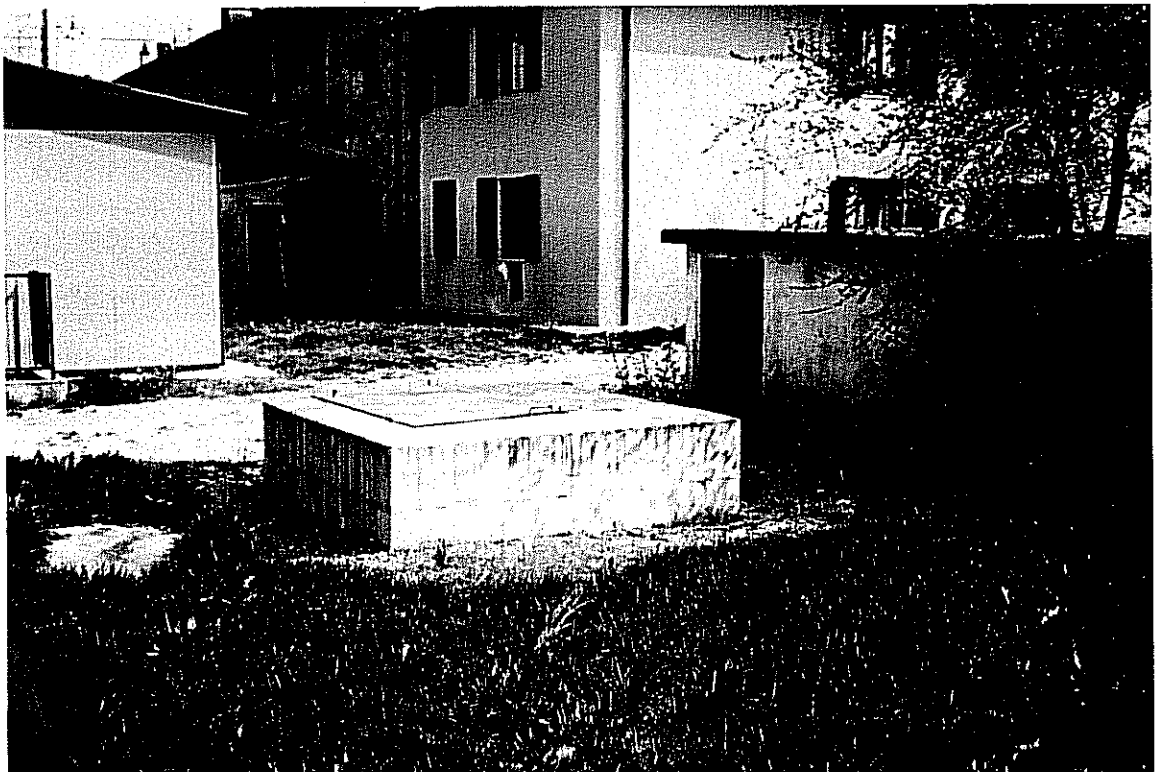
Il manufatto in cemento che racchiude il pozzo dell'acquedotto comunale in Via Cavour.
